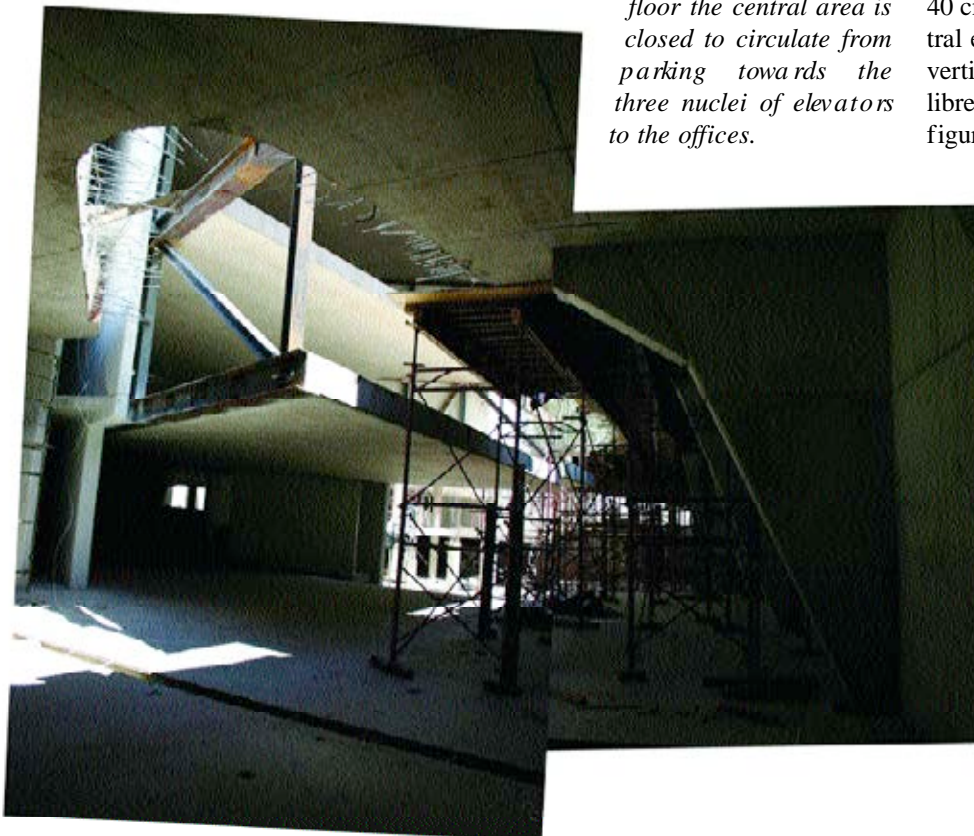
Vista diagonal de módulo de oficinas en el nivel -1,5 m y la planta sótano -1. En esta imagen se aprecia como el nivel de oficinas -1,5 m no conecta con la estructura de las ménsulas y, por tanto, adicionalmente no se dispone en este nivel de un diafragma rígido.
